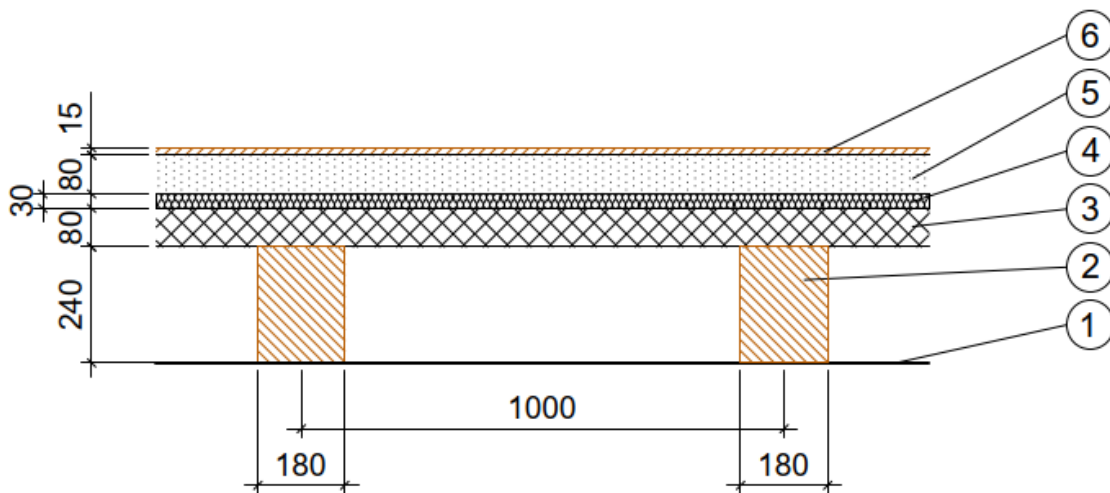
Aufbau Holz-Beton-Verbunddecke (Holzbalken)
